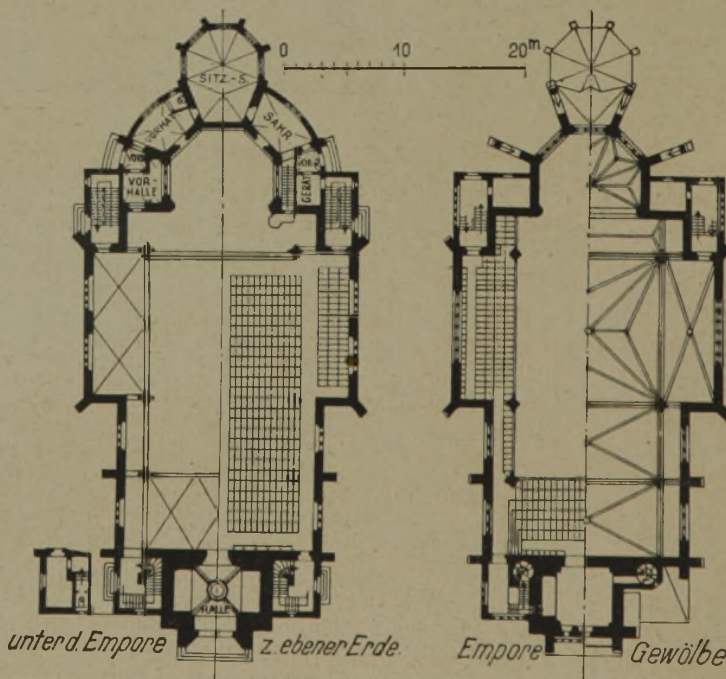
u. 5. Grundrisse. (1:600.)
